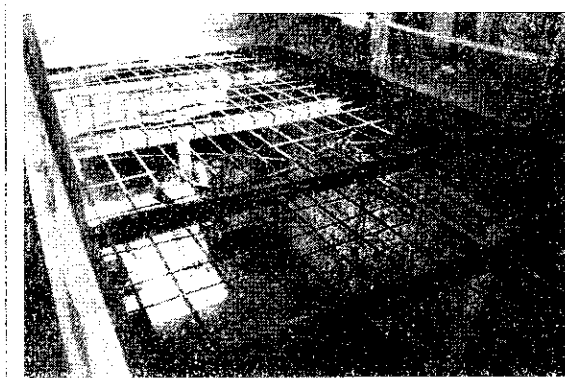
Malla de refuerzo para construcción de placa. Se observa un intento fallido de construcción por parte de los residentes.
